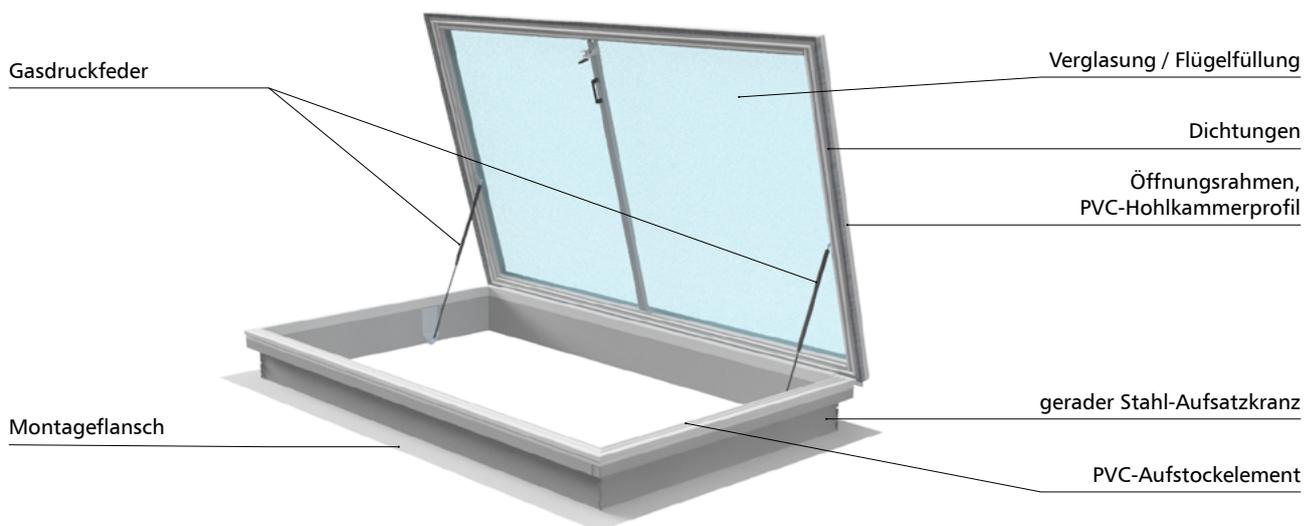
Aufbau des Dachausstiegs mcr ULTRA THERM Typ E
